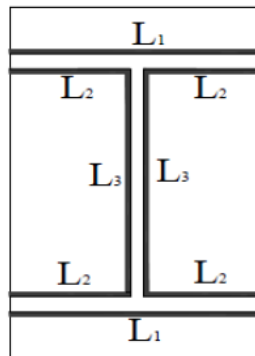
Assemblage soude poutre-platine
